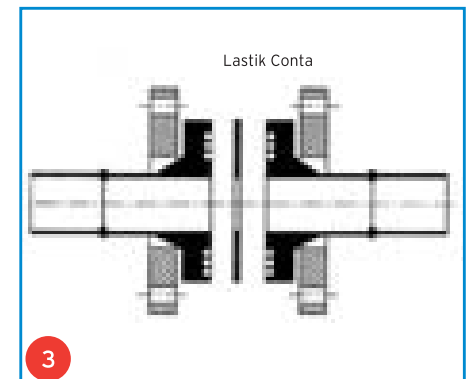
Dizayn 100 temiz su boruları flanşlı birleştirme tekniği
